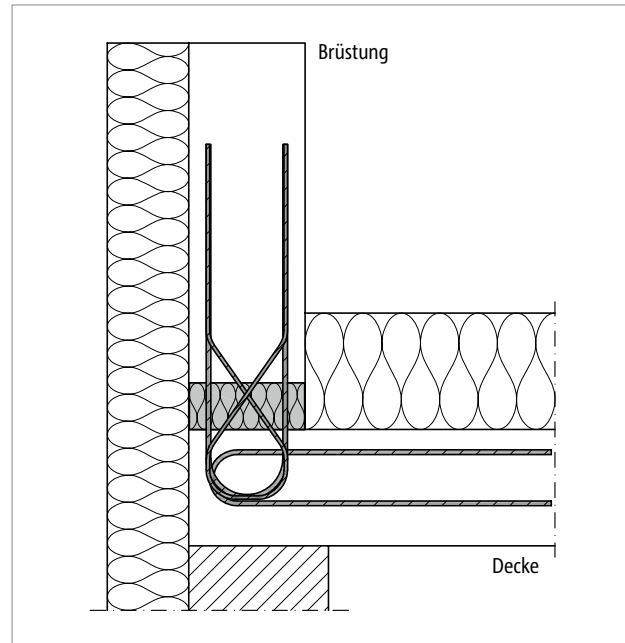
Schöck Isokorb® T Typ A: Anschluss einer Brüstung (T Typ A-MM2)
